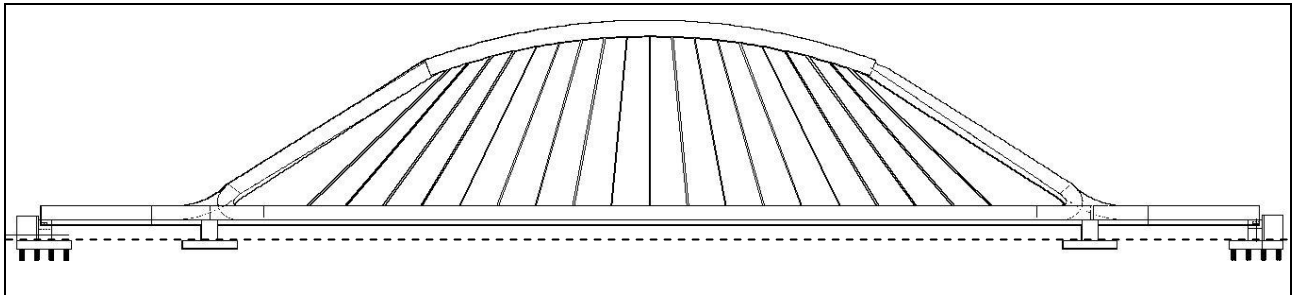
/1 Viadotto Cartiera - Prospetto
